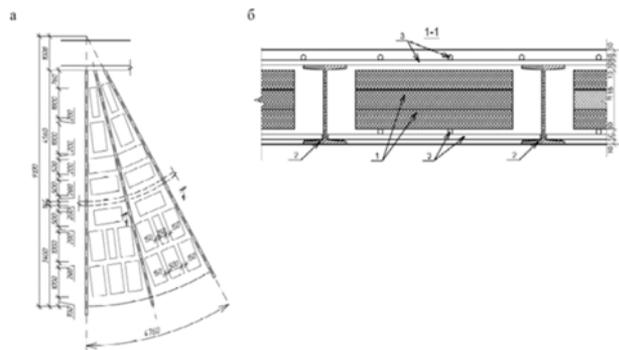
Фрагмент (а) и местное сечение (б) круглого перекрытия с пенопластовыми вставками: 1 – пенопластовые вставки; 2 – металлические балки; 3 – арматура
